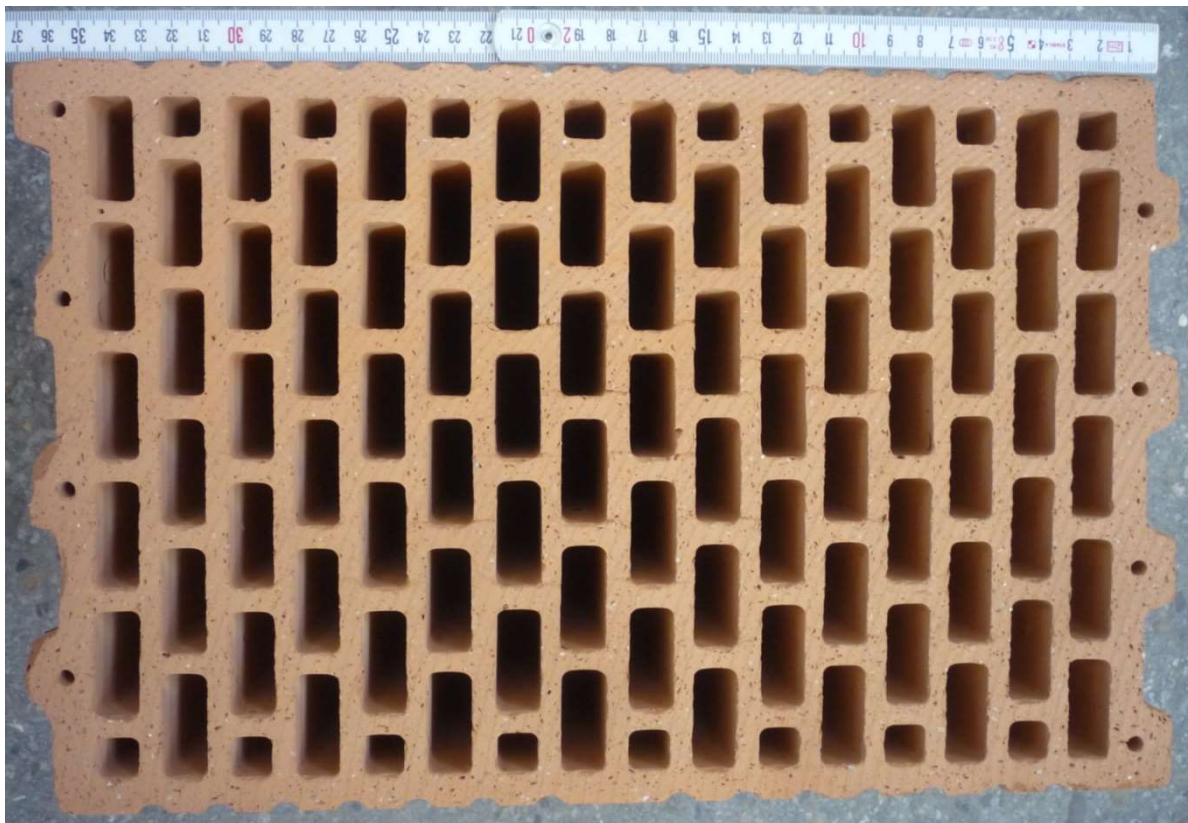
Draufsicht des Planziegels PHLz B (Breite 240 mm)
